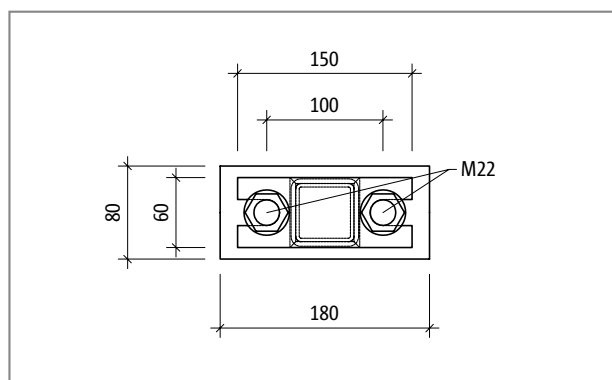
Schöck Isokorb® T typ S-V-D16: Řez prvkem
